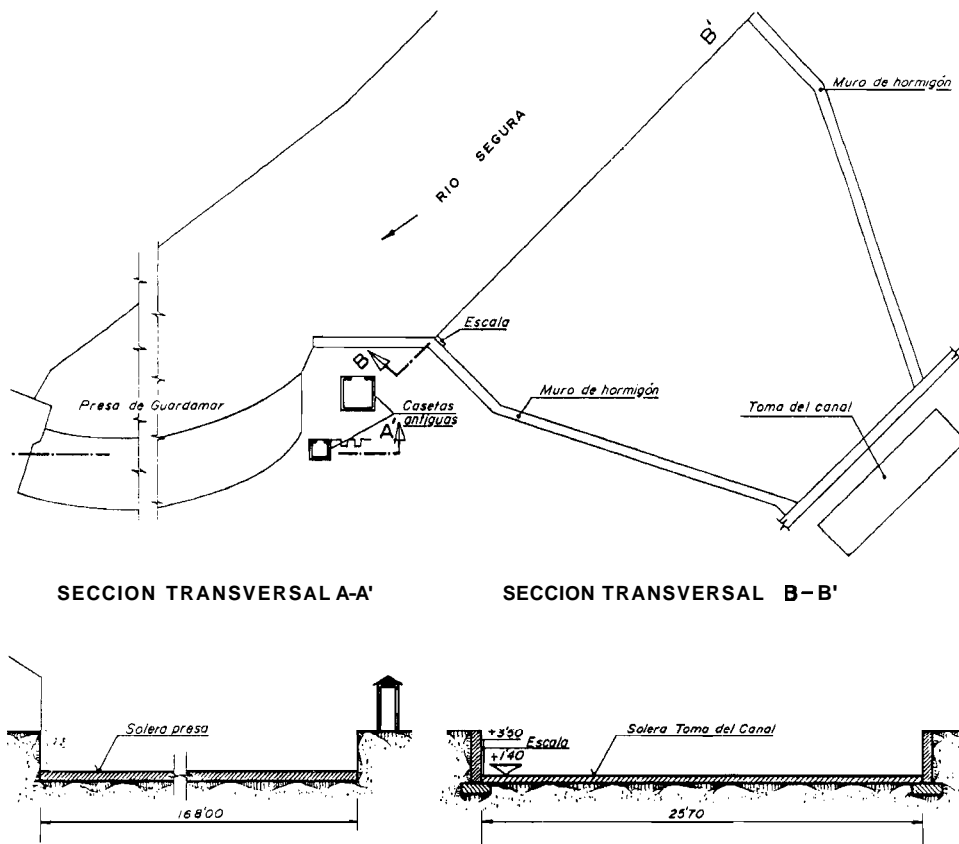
Planta y sección transversal de las estaciones de Guardamar (A-A') y Toma del Canal de Riegos de Levante, margen izquierda (B-B').
